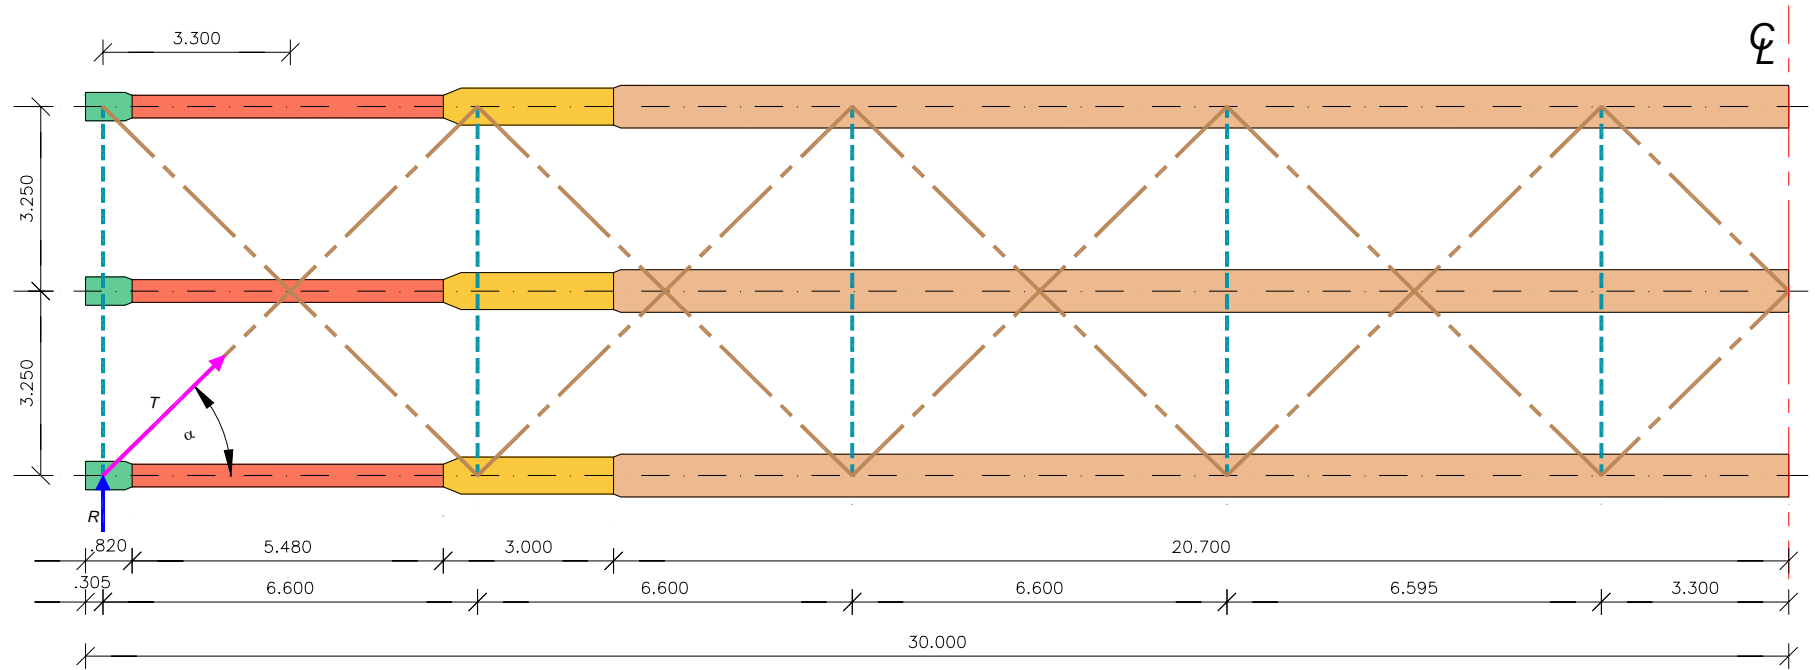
Configuración en planta de Arriostramientos inferiores (Vista desde Abajo)
